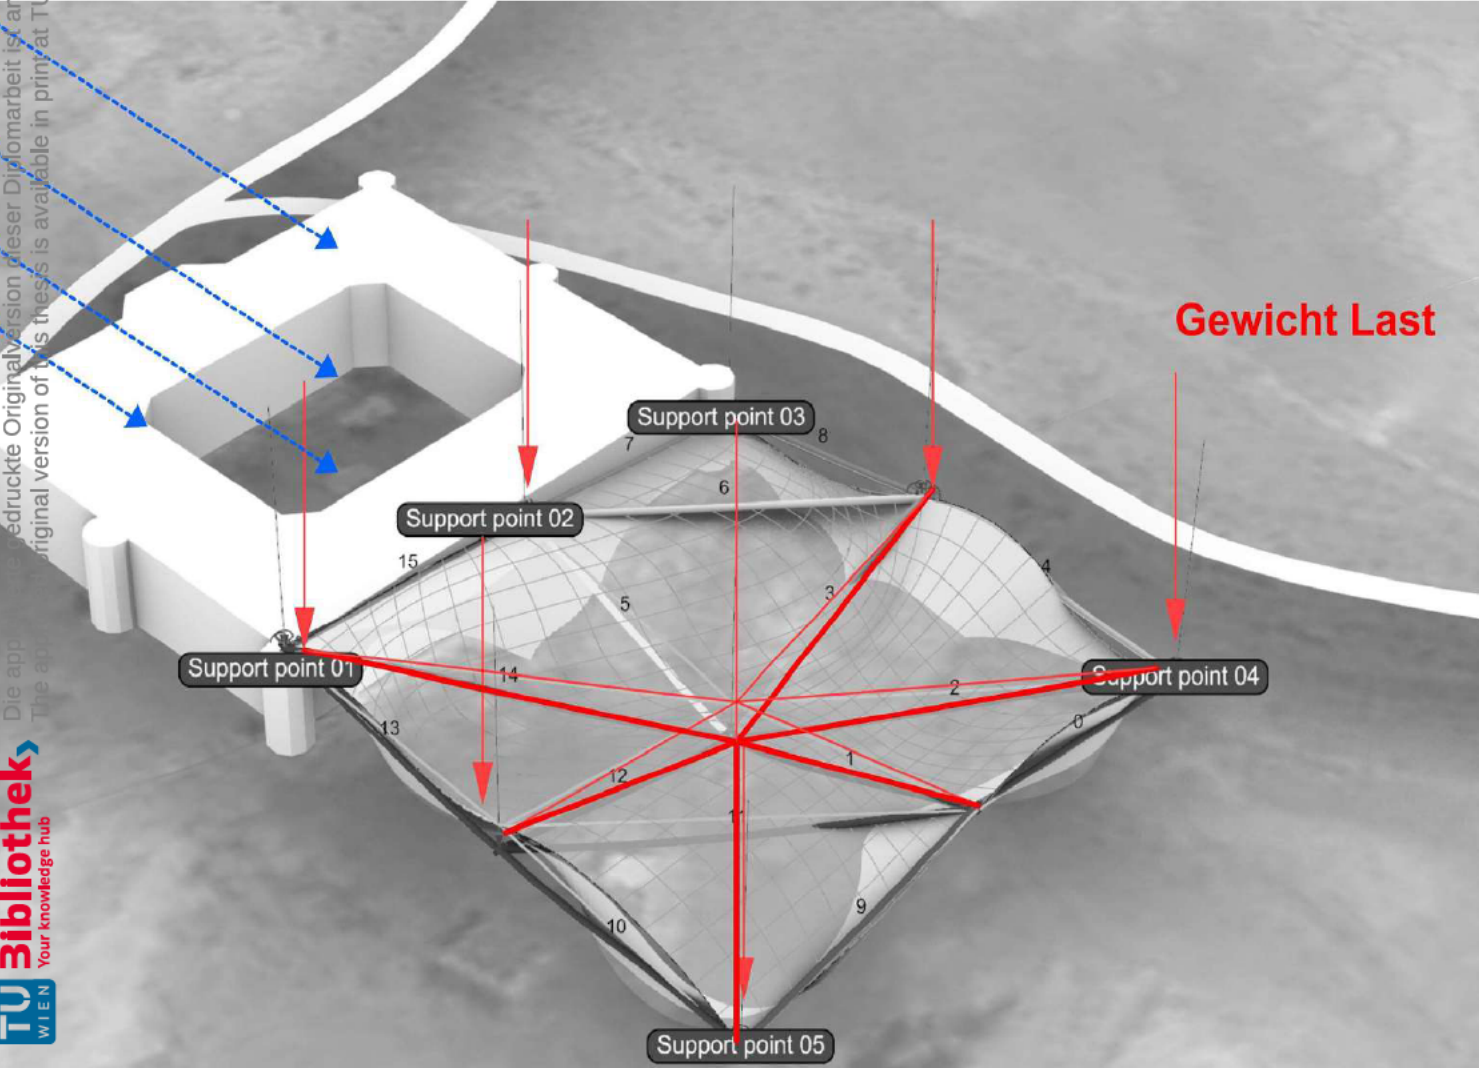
einwirkende Kräfte auf das Bauwerk, Windrichtung
